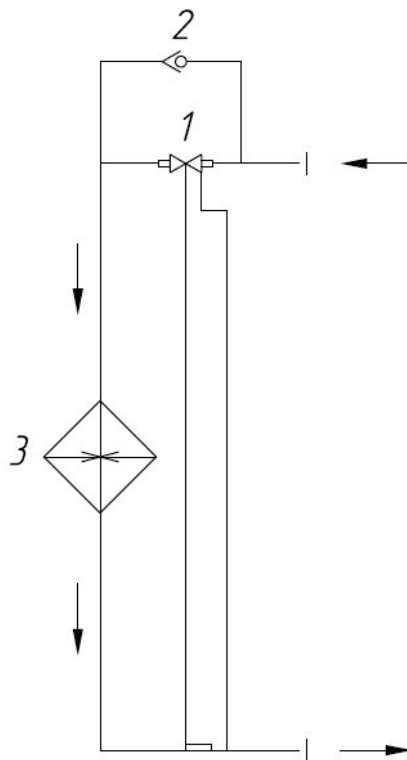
Монтаж испарителя для агрегатов с реверсивным холодильным контуром (агрегатов компрессорного типа МАКК-Т, а также КРАБ с опцией «Т»)
